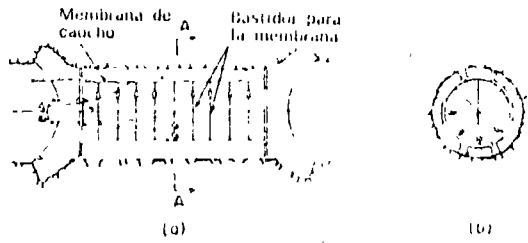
Ensayo de presión en galería normalizado. (a) Galería en sección longitudinal; (b) Sección A-A
